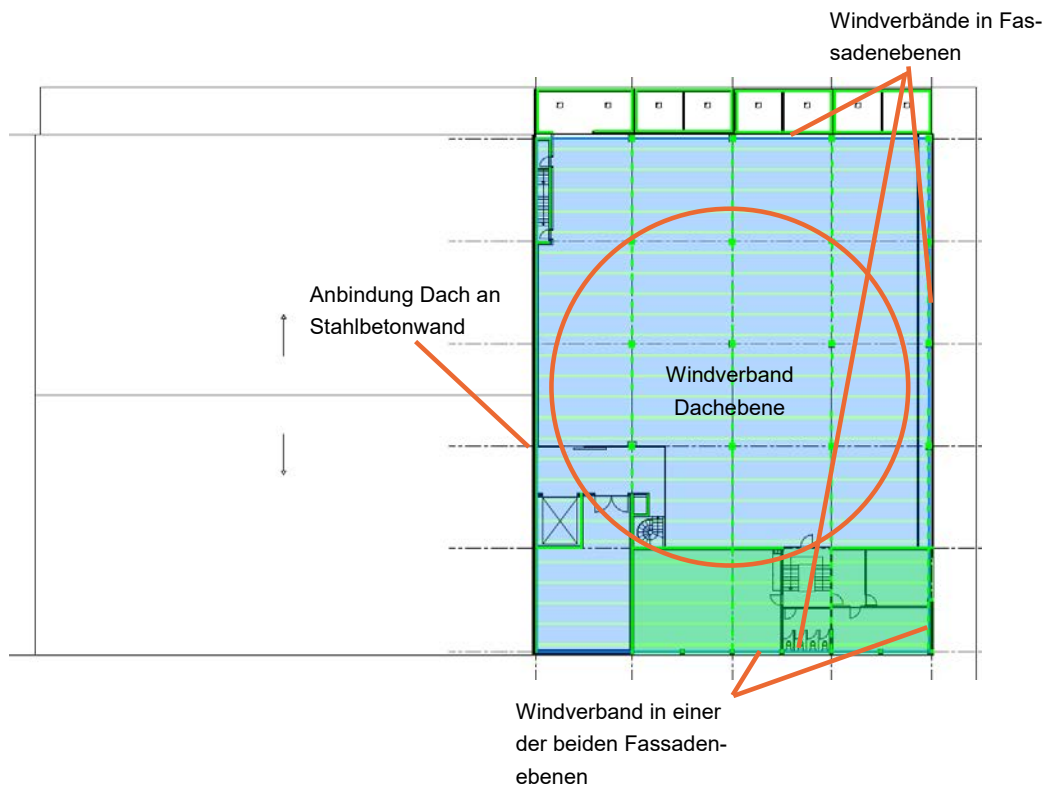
Grundriss OG Kartoffelzentrum: mögliche Massnahmen am Tragwerk
